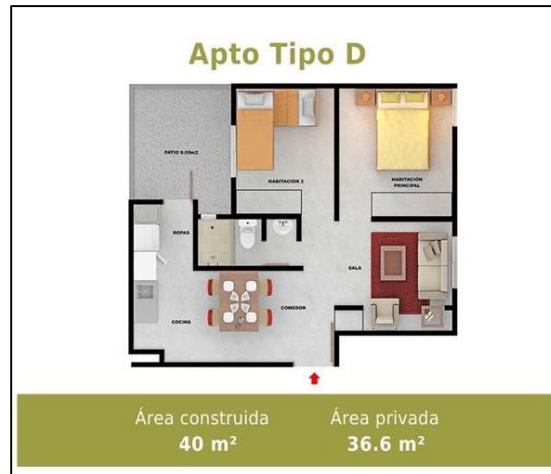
Planta Arquitectónica Tipo D. SIN ESCALA.
